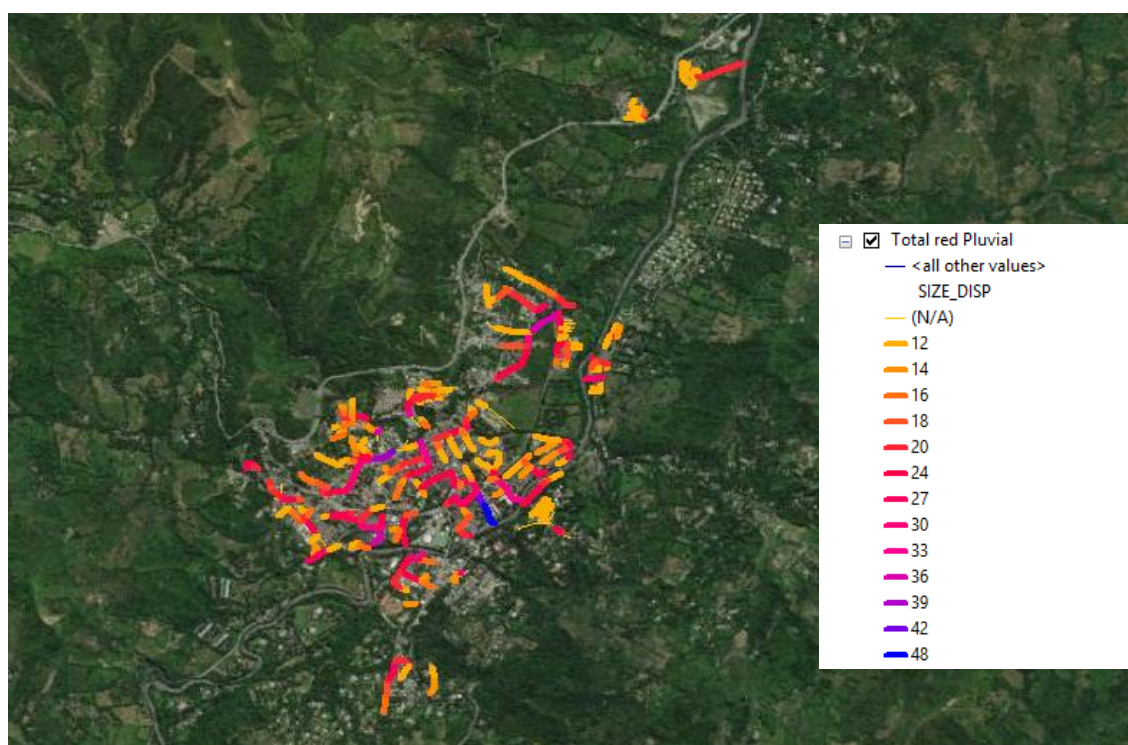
Redes proyectadas de alcantarillado pluvial. Distribución de diámetros.
